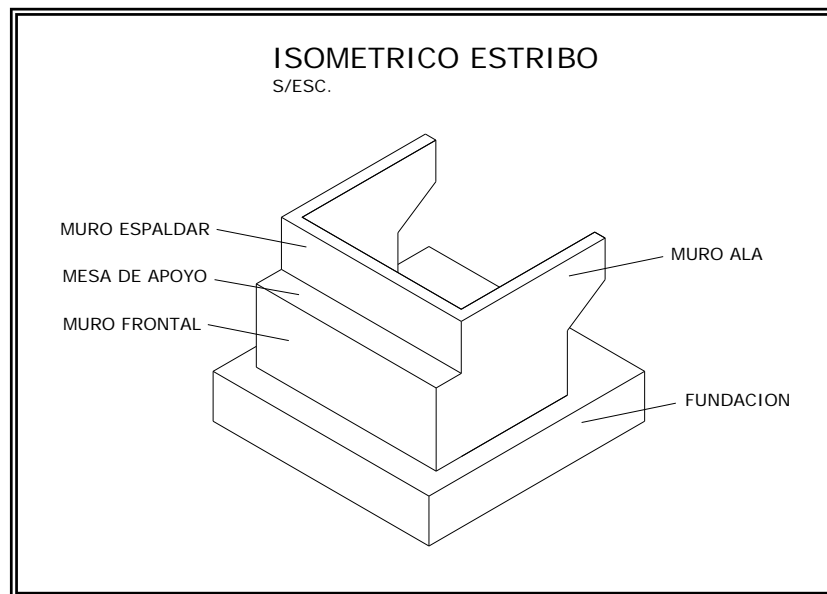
Estribo tipo construido como apoyo en los extremos de un puente.
